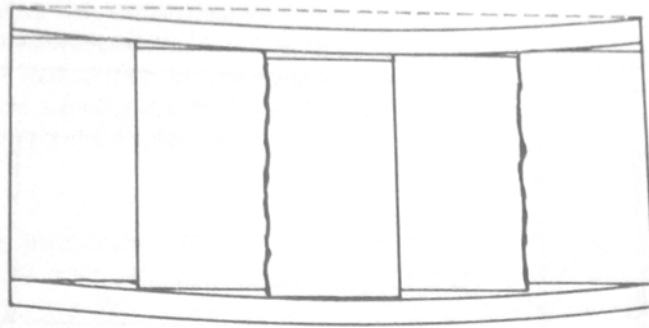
Cisalhamento entre painéis pré-fabricados, provocado pela deflexão dos componentes estruturais. (Fonte: THOMAZ)
